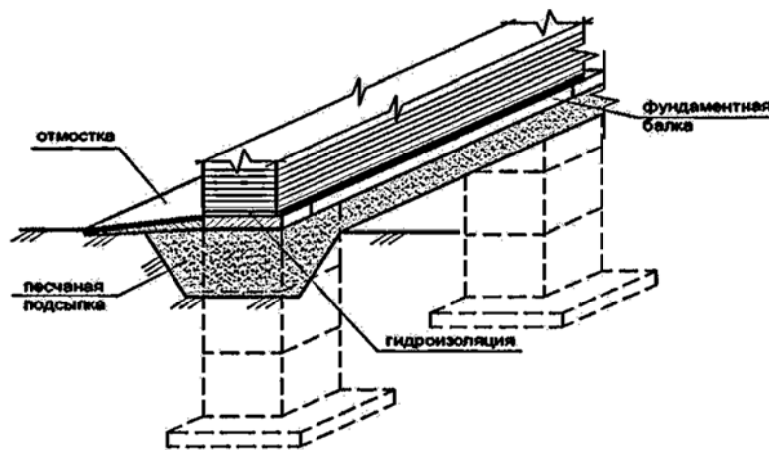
Столбчатые фундаменты малоэтажных зданий под каменные стены
